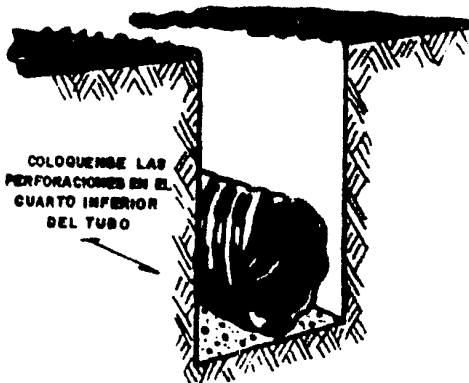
GENERALMENTE EL TUBO DEBE INSTALARSE CON LAS PERFORACIONES HACIA ABAJO.
